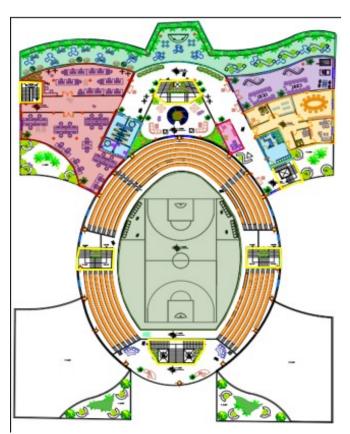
plan du 2^{eme} étage. Source : auteurs.
